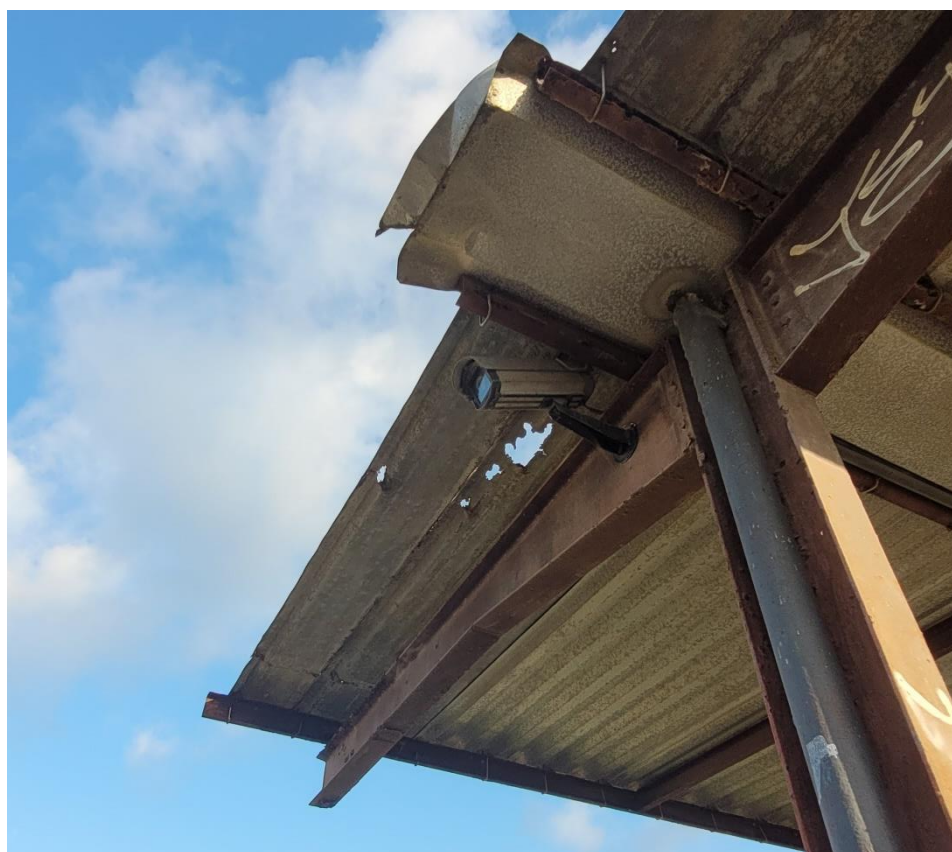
Telhas metálicas apresentando furos e desgaste
